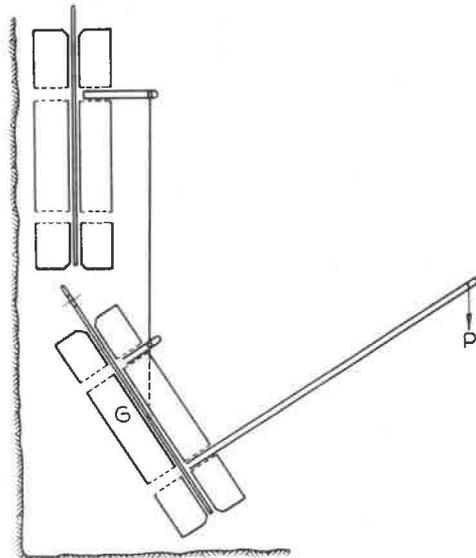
Leviers introduits dans les trous inférieurs T des claveaux pour en faciliter la manœuvre et le basculement.
